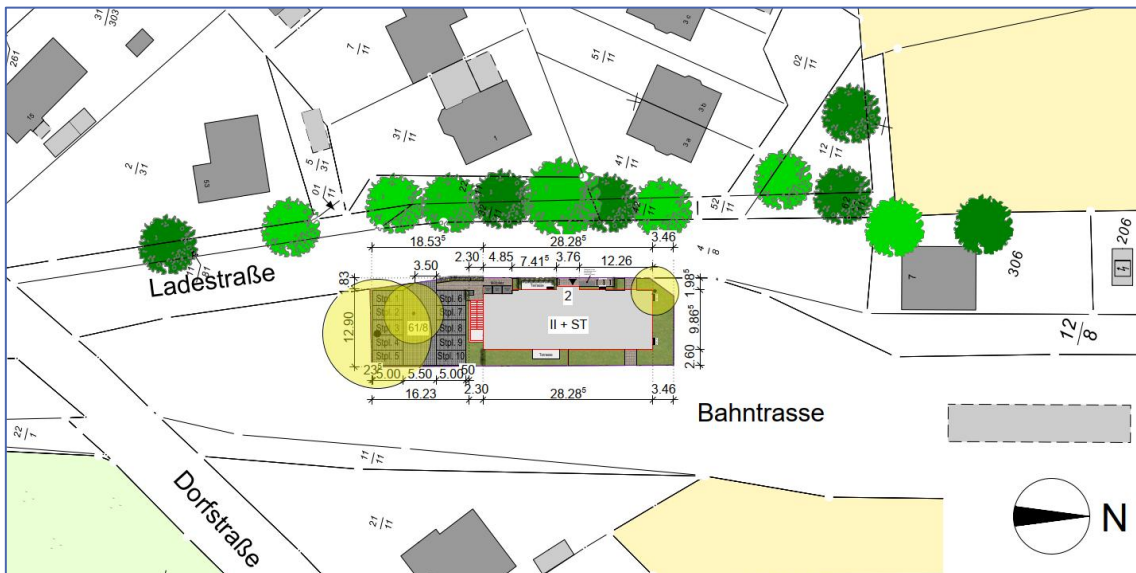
Lageplan Neubau, THPA 341 mbH (Stand: 16.10.2023)
